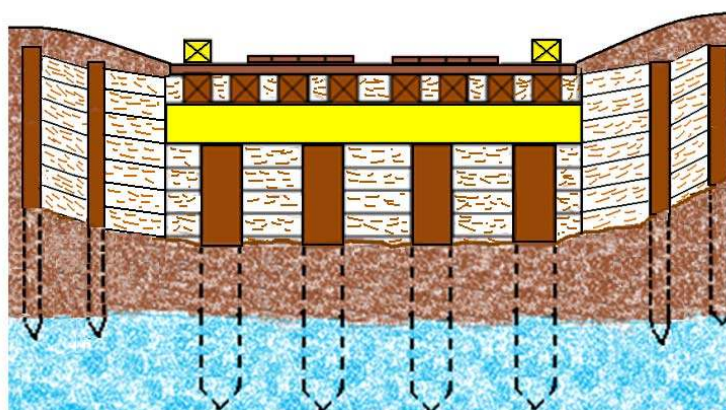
Encontro com contenção de pranchões de madeira (caixote)
